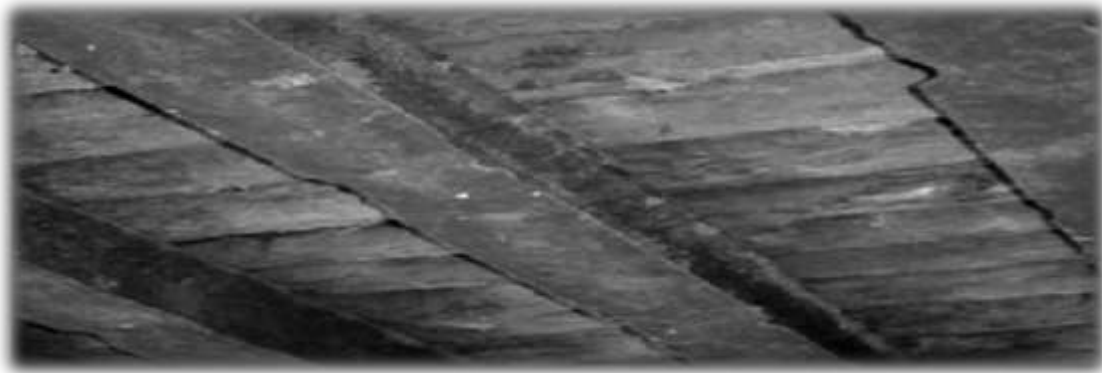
Fotografía De La Corrosión De Las Vigas Longitudinales Y Mal Estado De Los Troncos De Madera Transversales.
